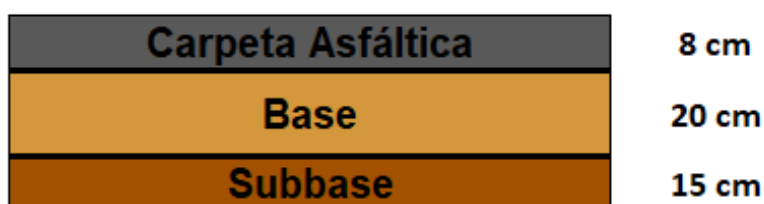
Espesores de capas del Pavimento de la Av. Cesar Vallejo
